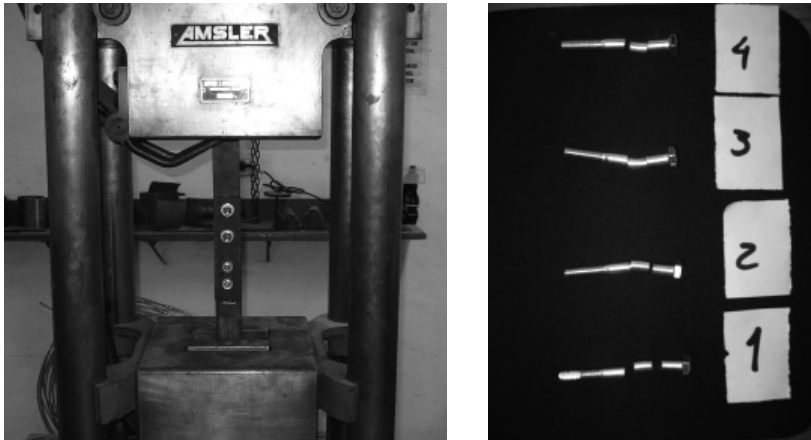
Ensayos a corte simple en planchas traccionadas
